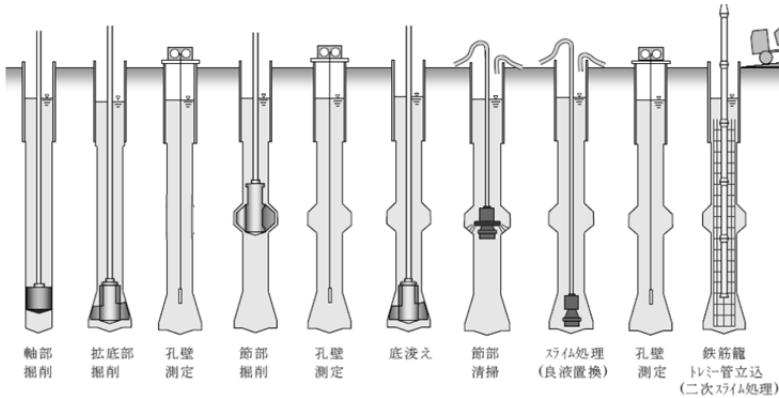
節付き場所打ちコンクリート杭の施工手順
